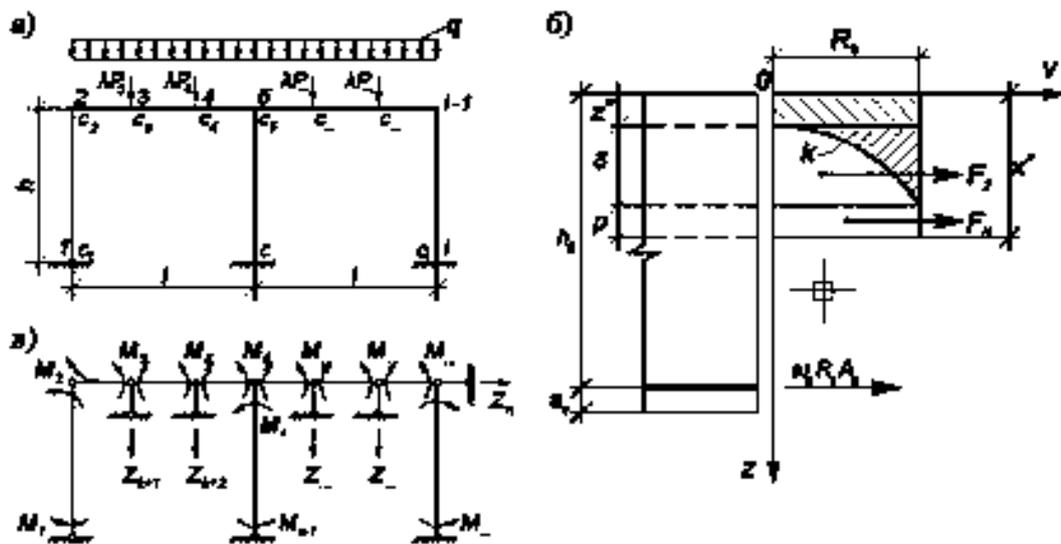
Заданная (а), основная (б) системы рамы и расчетная схема поперечного сечения железобетонного элемента (в)
